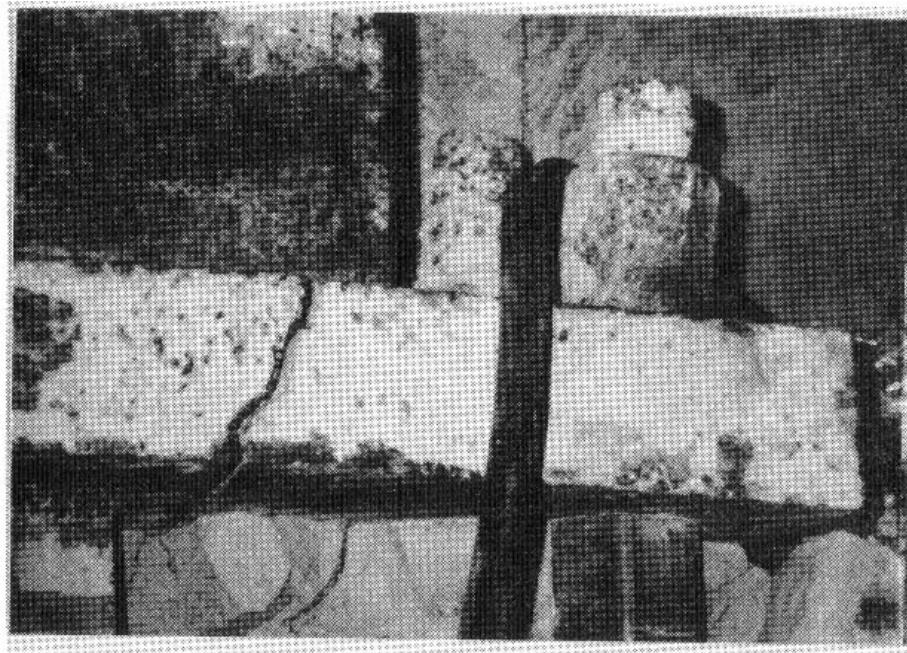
Fractura de la plancha base de una columna. Ref. 5
